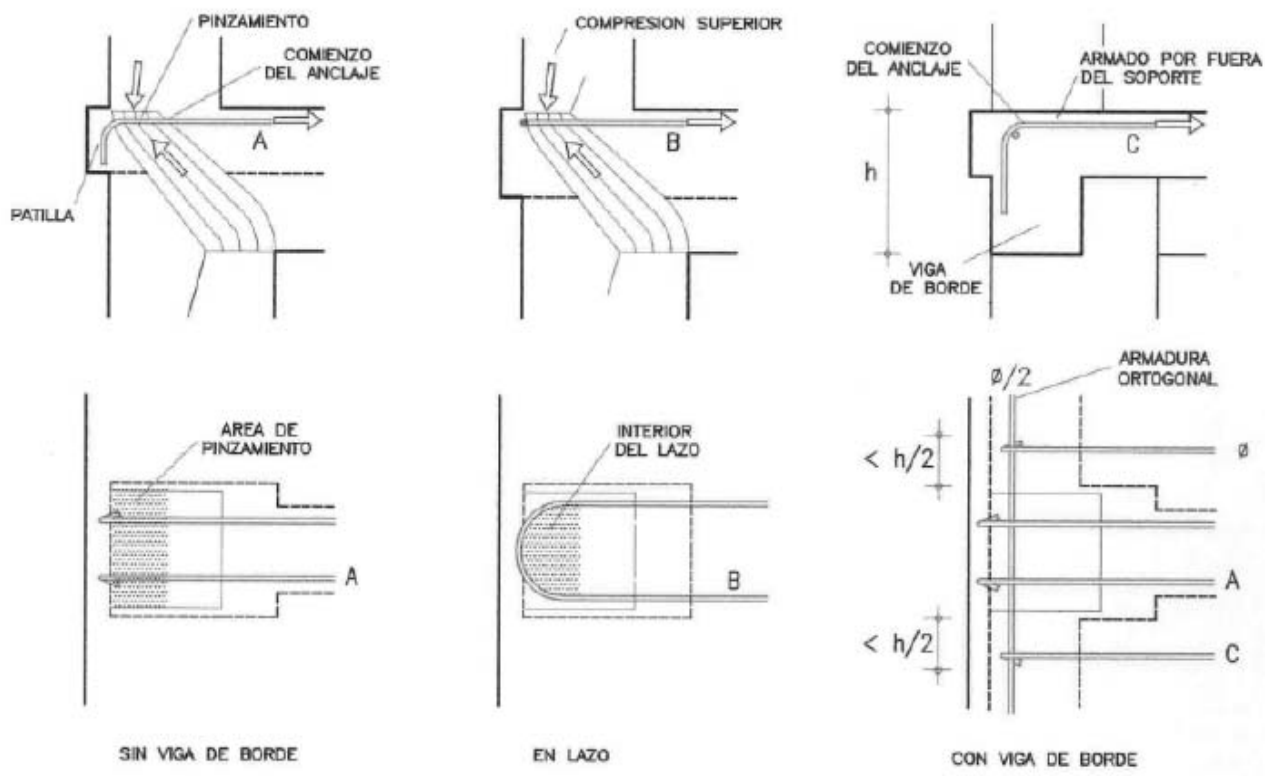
Armaduras superiores en nó extremo con soporte de formigón
